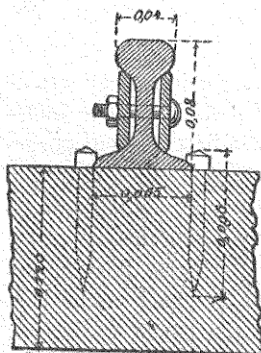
Tramway de Villiers-le-Bel. Profil en travers. Echelle 1/5.
